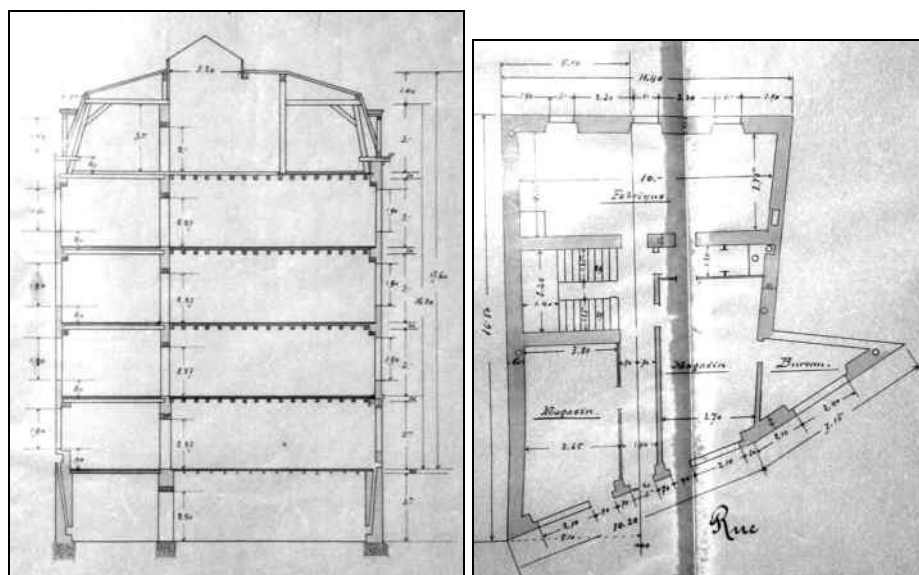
Coupe transversale et plan du rez-de-chaussée du bâtiment n°16
